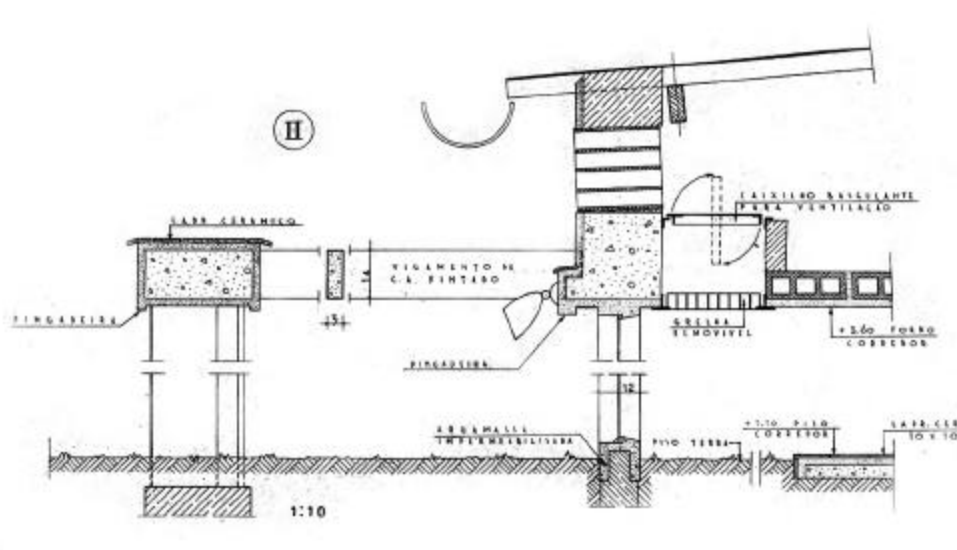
Detalhe construtivo: grelha de ventilação na laje e tijolos furados para a ventilação da cobertura
